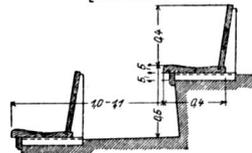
Grundrisse der Restaurationstribüne. — Abb. 269: Schnitt der Restaurationstribüne an der Querseite des Platzes (vgl. Abb. 264). — Abb. 270: Bänke mit Lehne.
